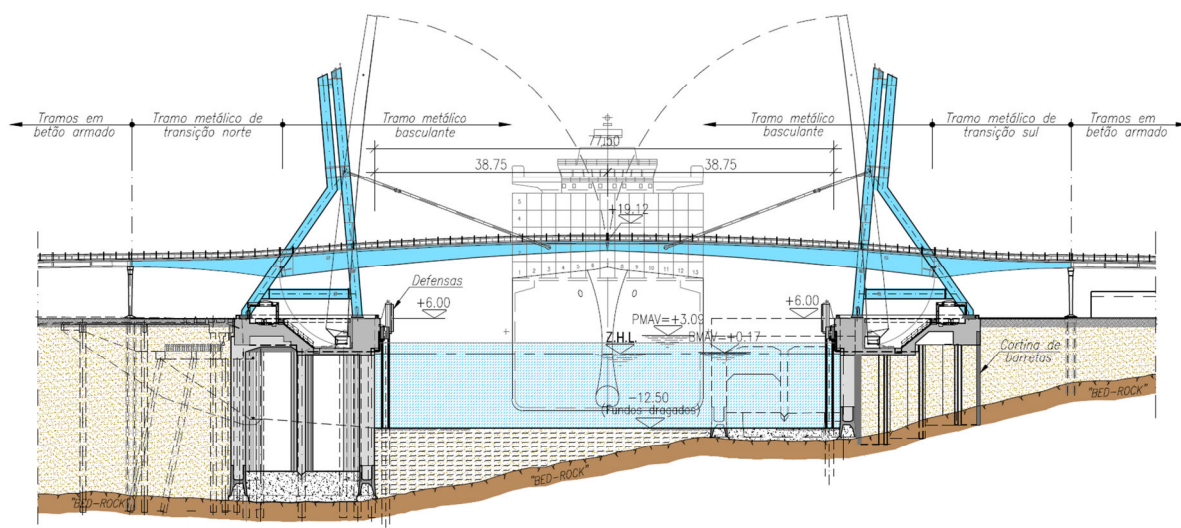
Fundações e geometria da Nova Ponte Móvel
